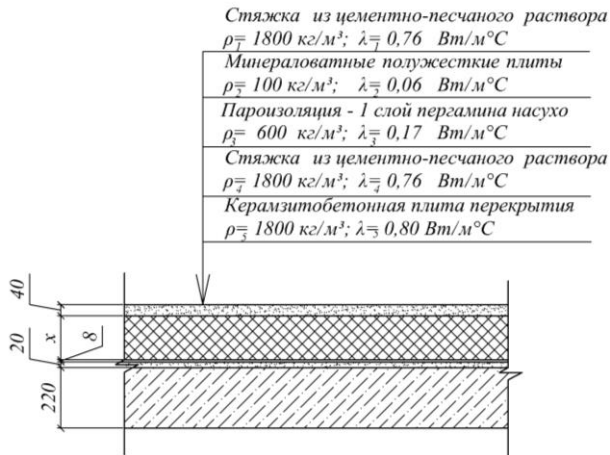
Схема к расчету утепленного чердачного перекрытия
